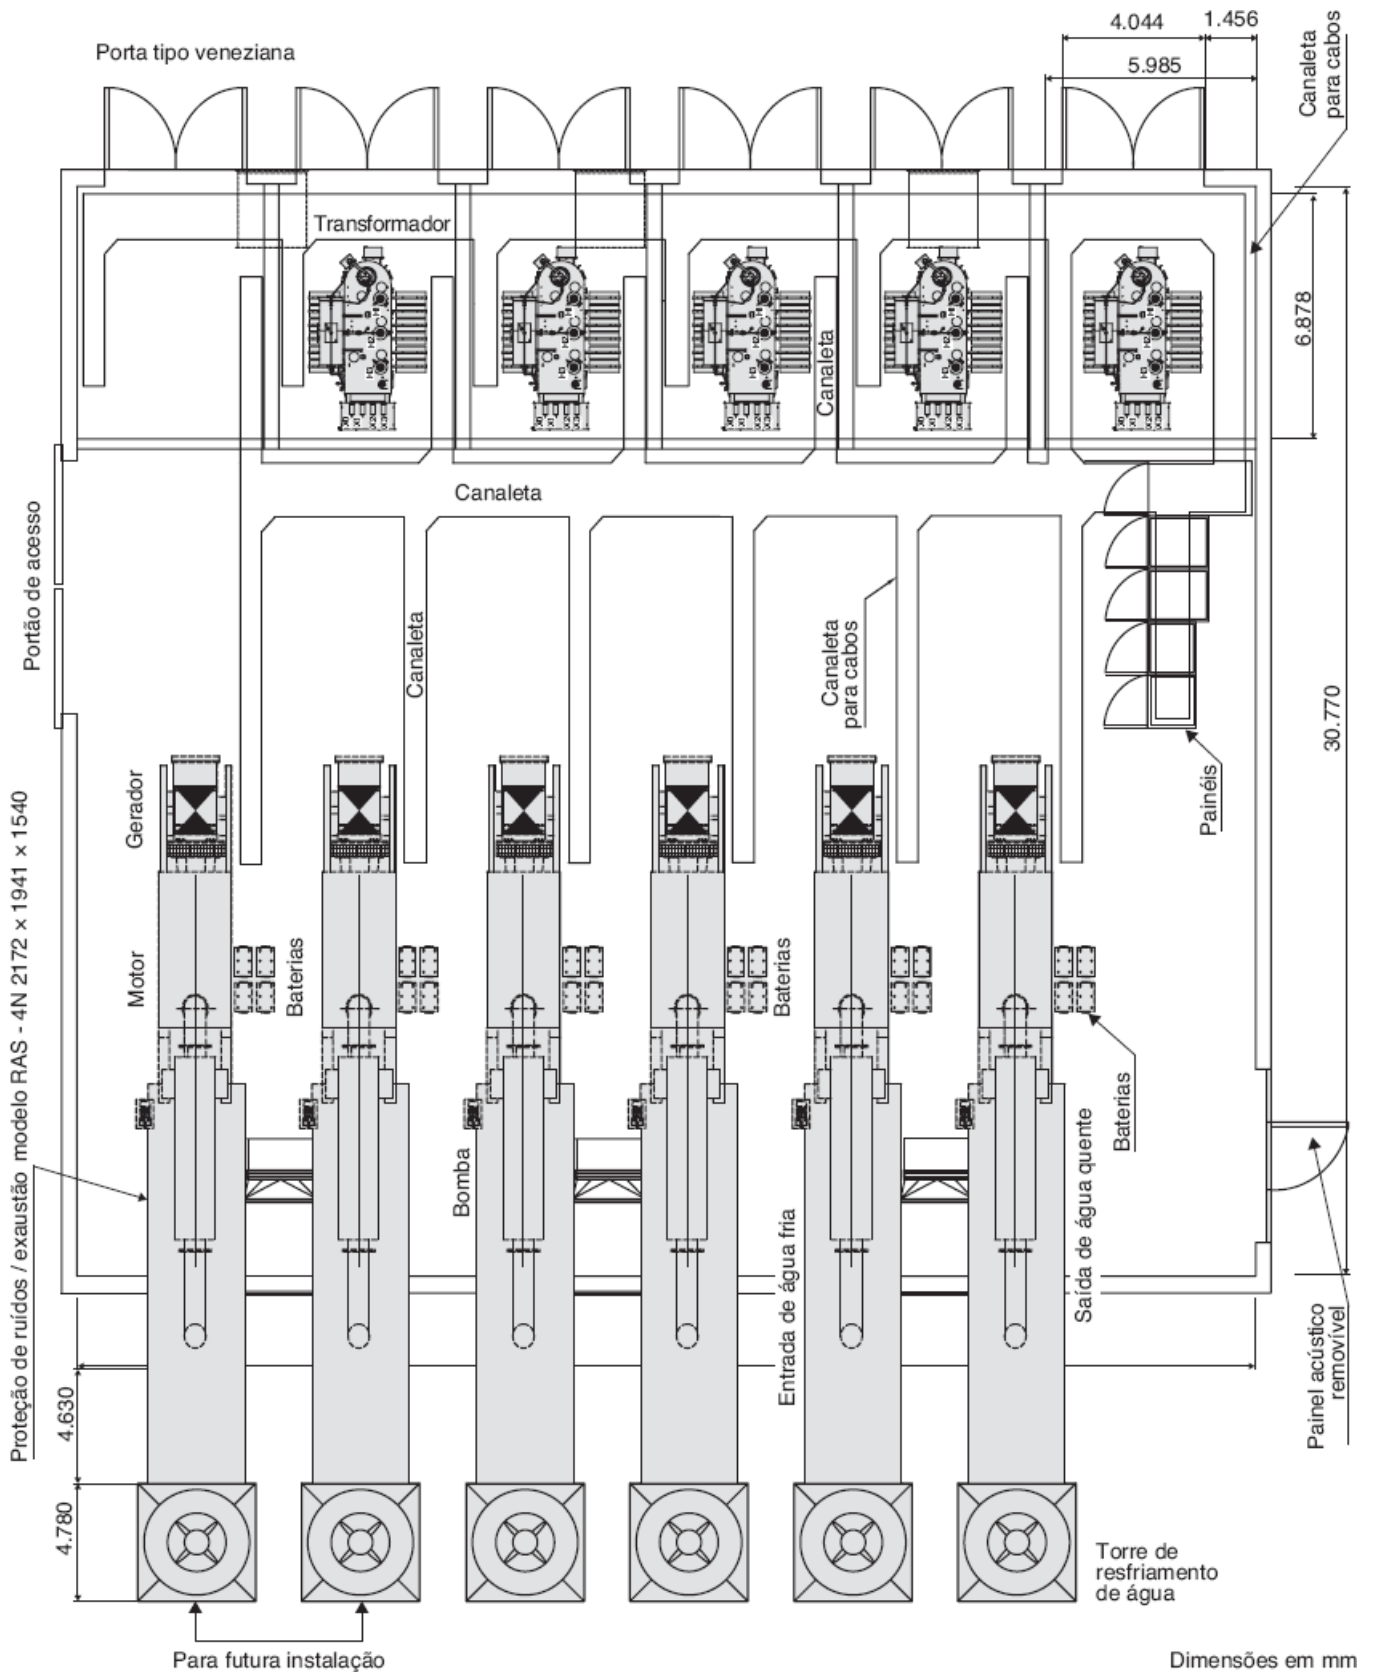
(a) Layout de uma usina termelétrica industrial.
